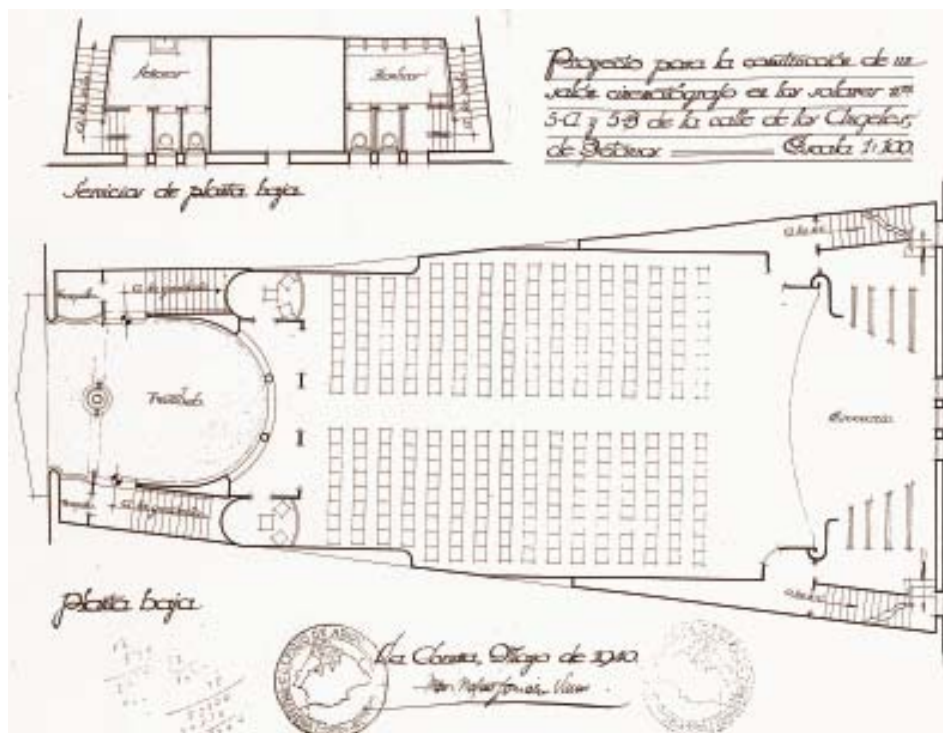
Planta baja del cine proyectado por Rafael González Villar en Betanzos, 1940.
